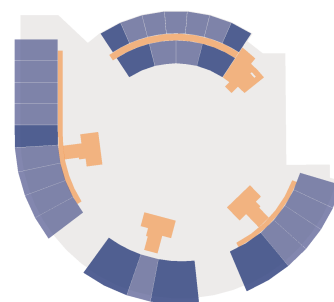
Planta do Décimo Sexto Pavimento.
